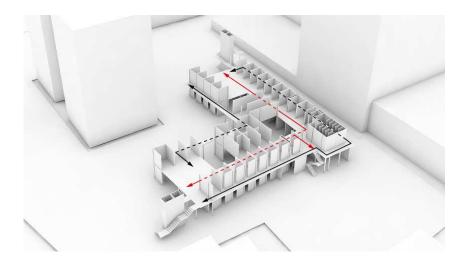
Direccionamiento de circulaciones internas en planta alta. Segunda Planta Alta
